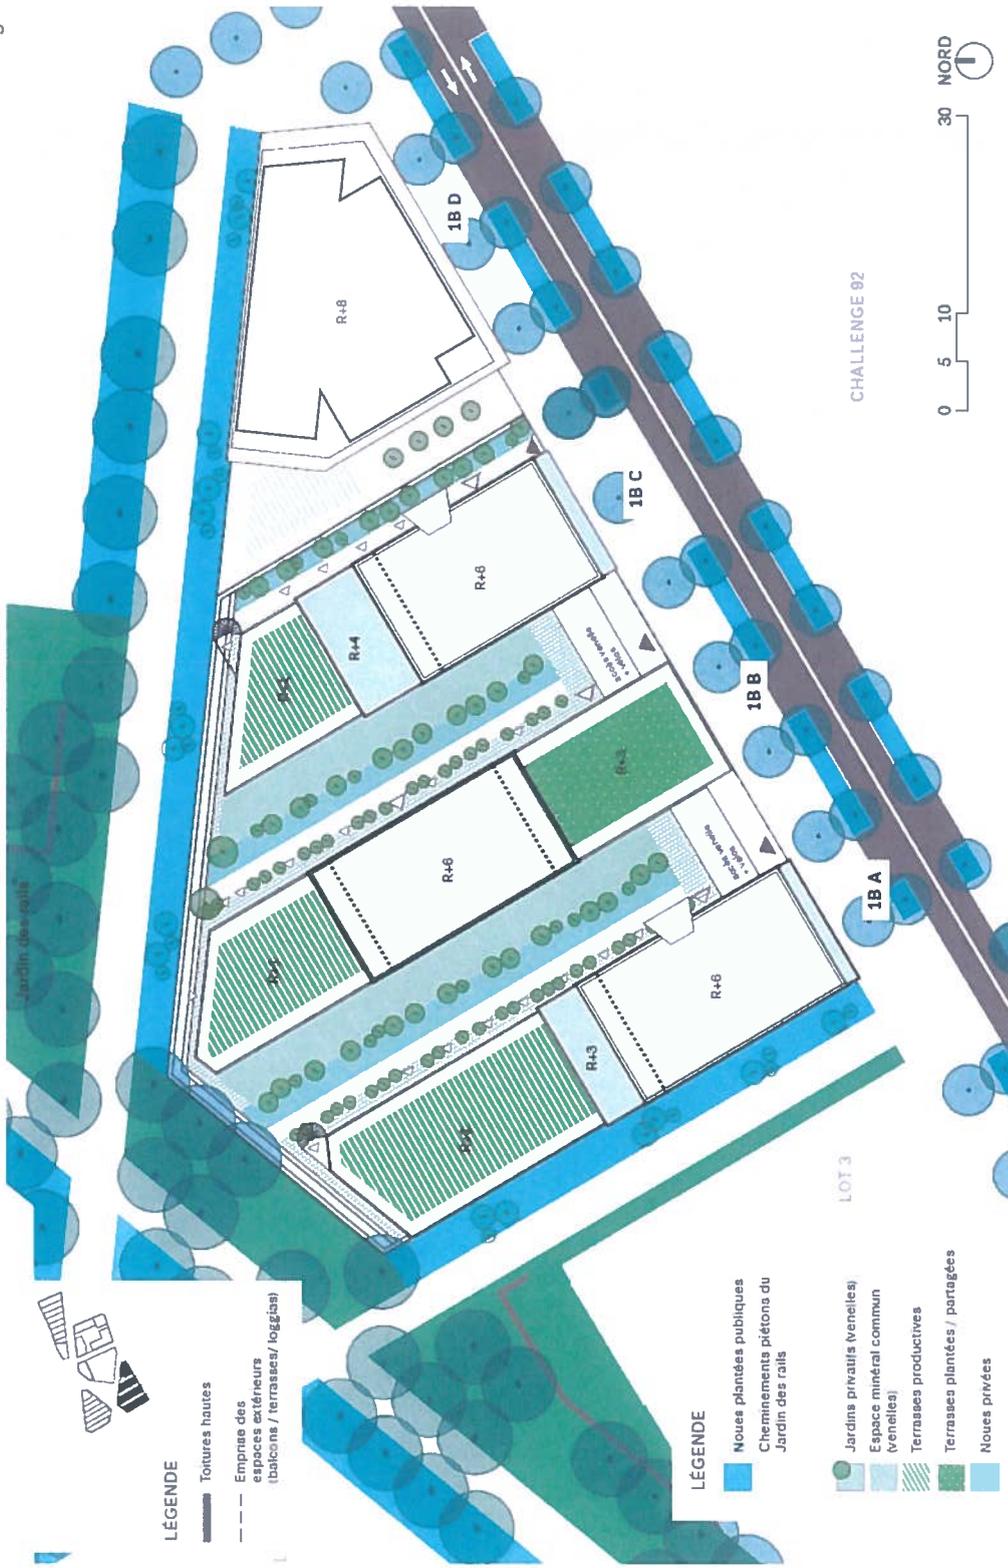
Plan de masse général du projet 1B – Martin Duplantier Architectes
